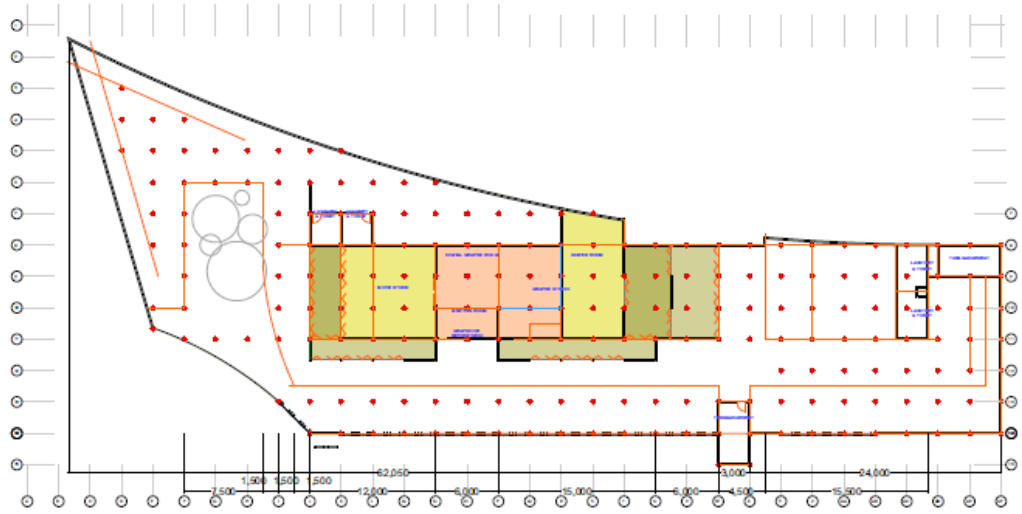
Site Plan Skematik Dakwah Media Center
